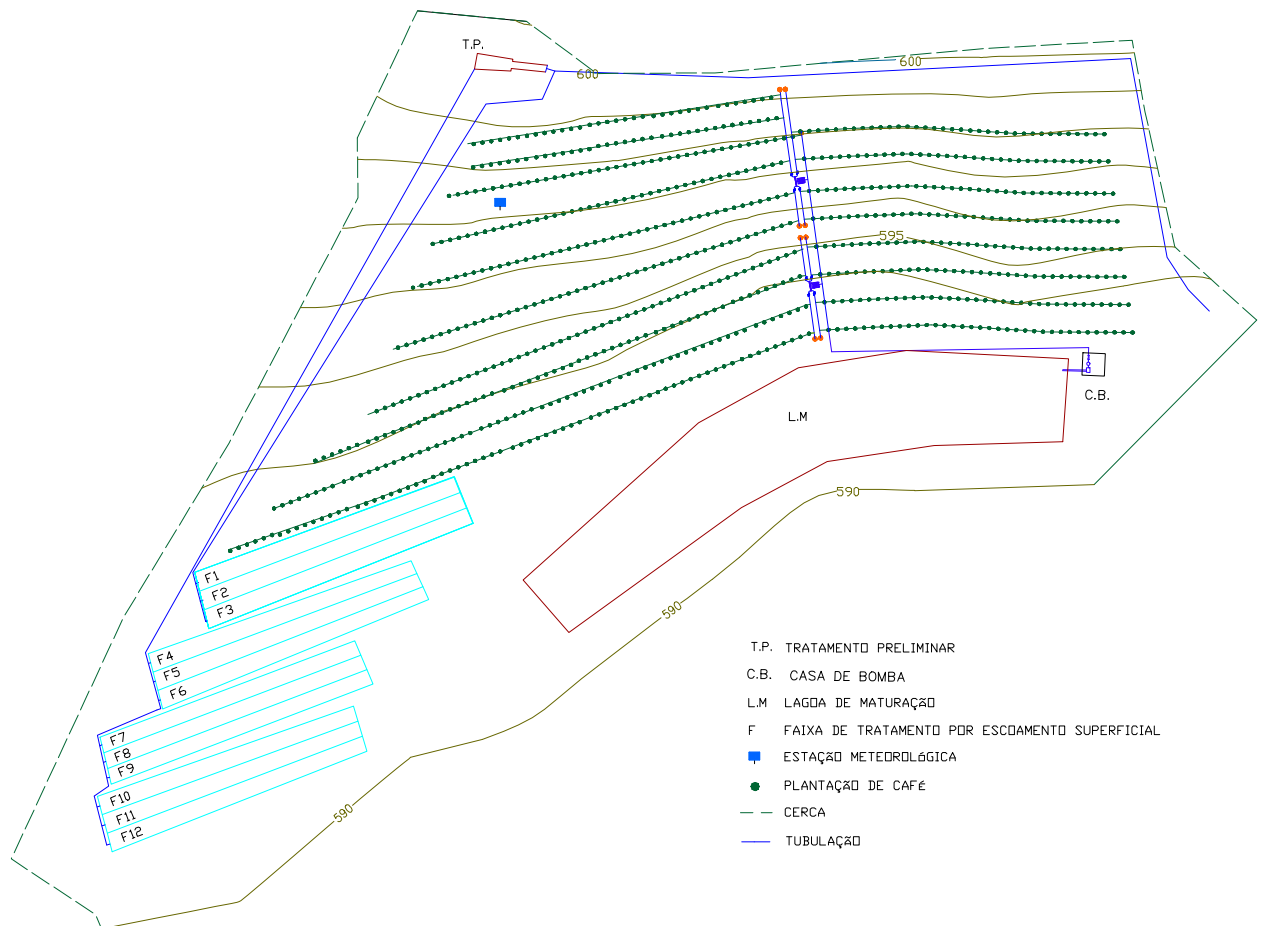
Croqui do sistema de tratamento do esgoto sanitário bruto e localização da subárea fertirrigada com esgoto sanitário da lagoa de maturação.
